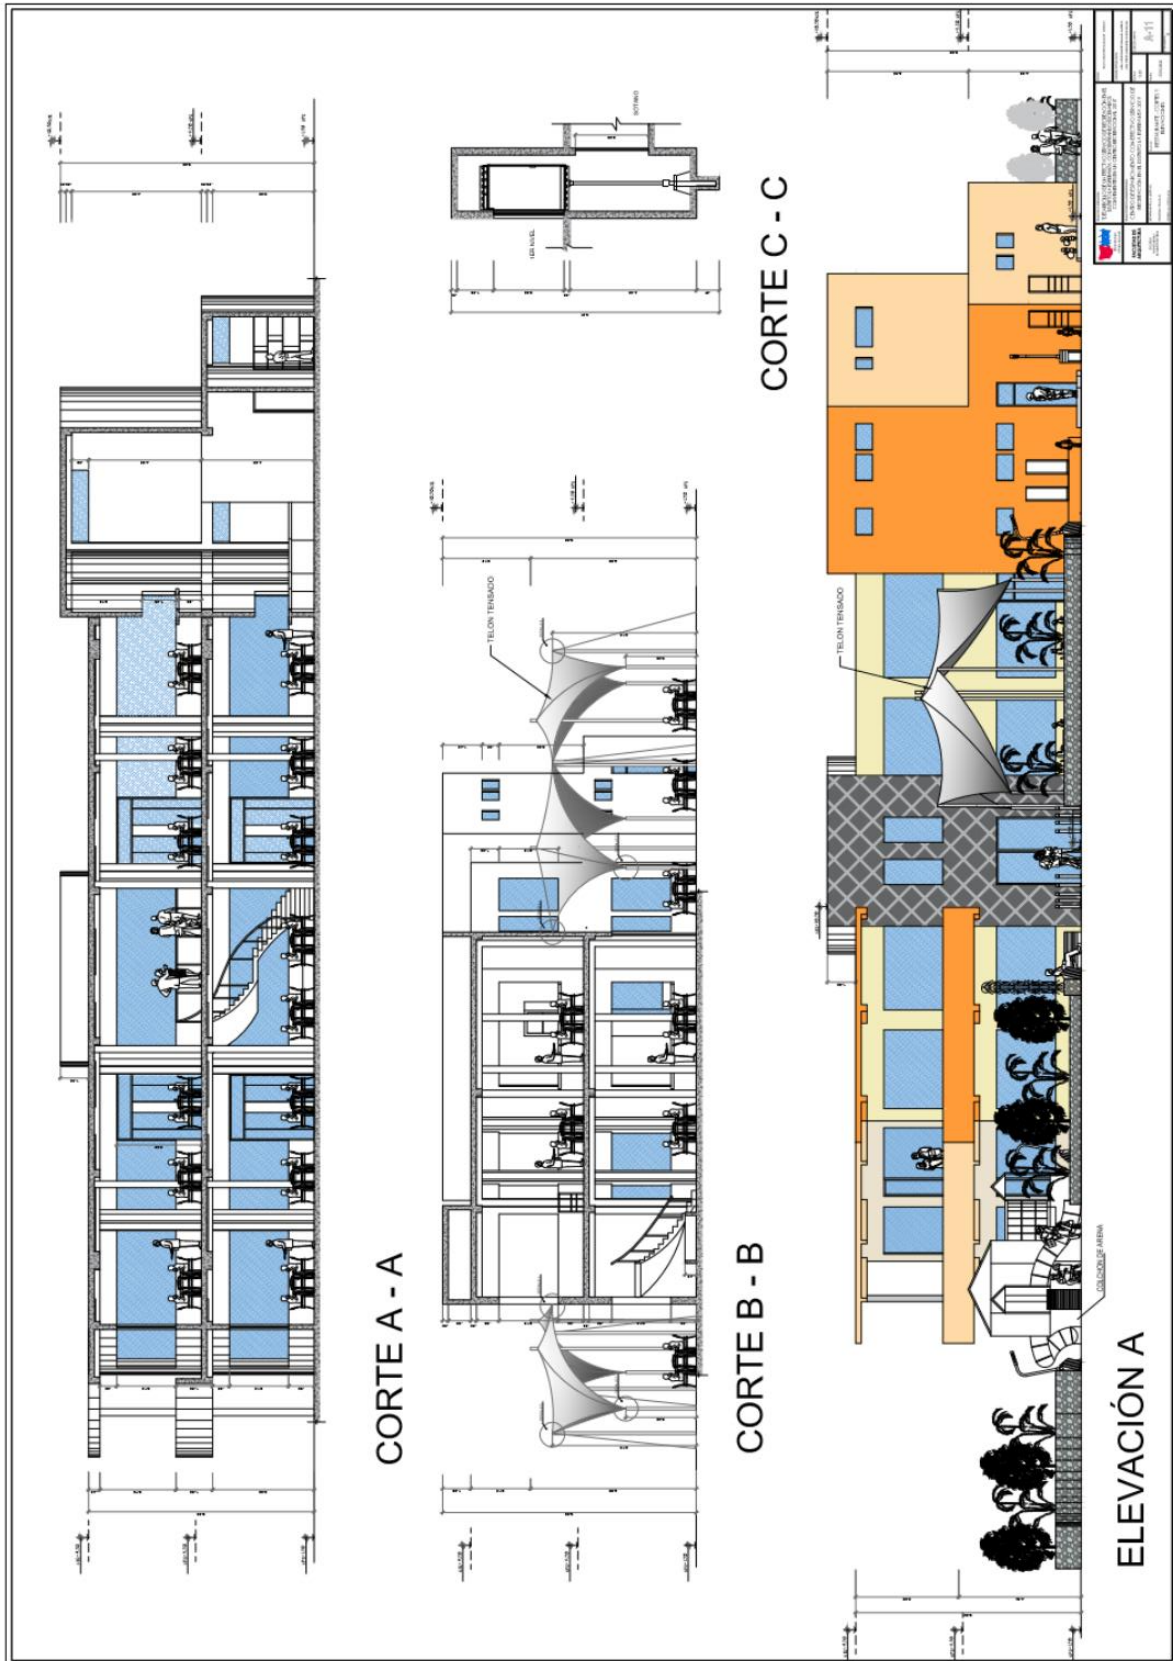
Plano de Restaurante- Cortes y Elevaciones. Elaboración propia.
